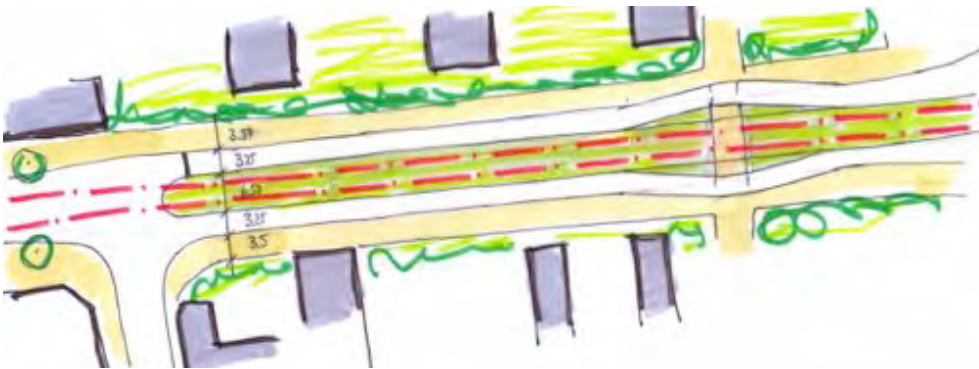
Ein besonderer Bahnkörper mit zwei Gleisen dient der Herstellung der Pulkführung am Knoten Burgstraße sowie zur landwärtigen Stauraumumfahrung. Die Einordnung von Radverkehrsanlagen ist nur eingeschränkt möglich. Ein Linksabbieger ist hierbei ebenfalls nicht möglich.
